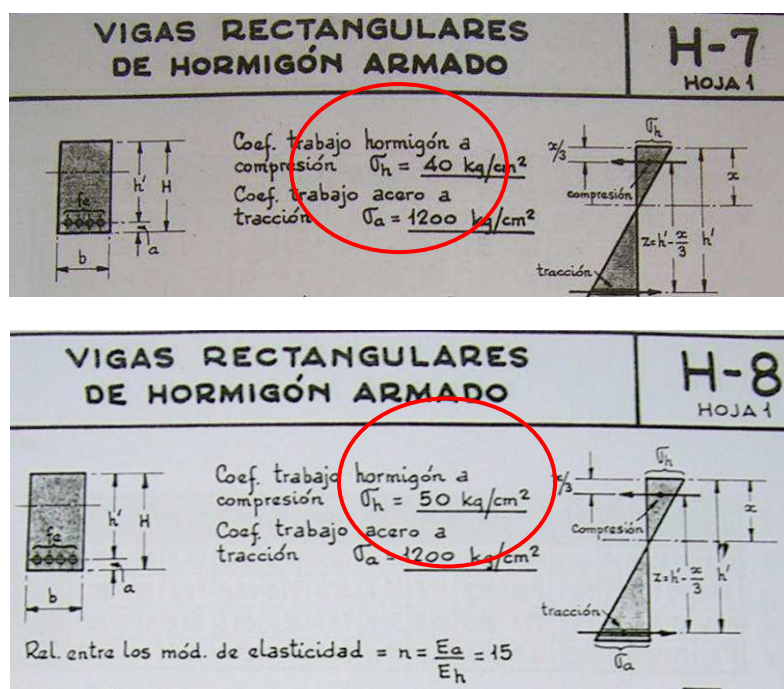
Tablas de cálculo del Arquitecto Ros, década de los sesenta.
